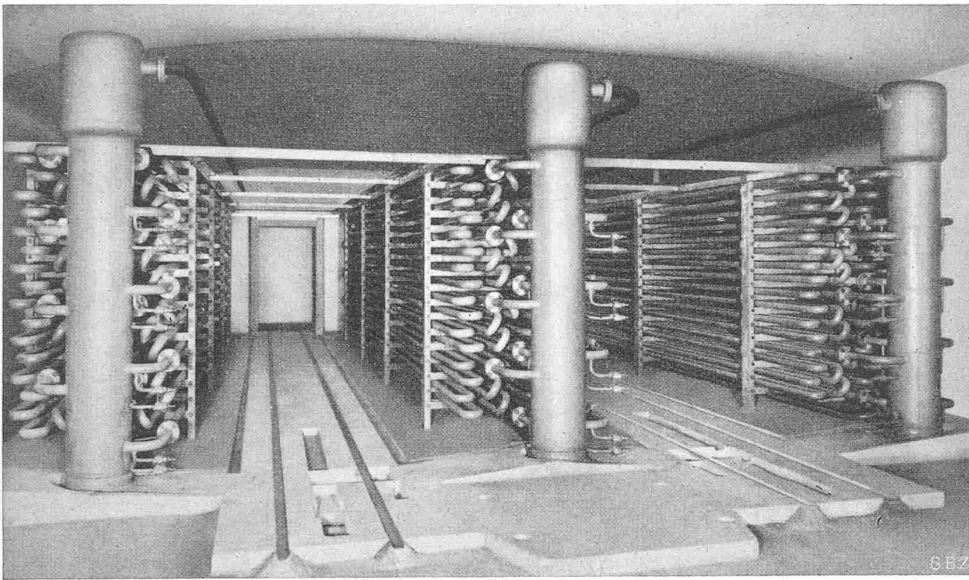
Blick aus dem Laderaum K in die Kühl tunnel, in Montage, vor Anbau der Einfahrtsschleusen
